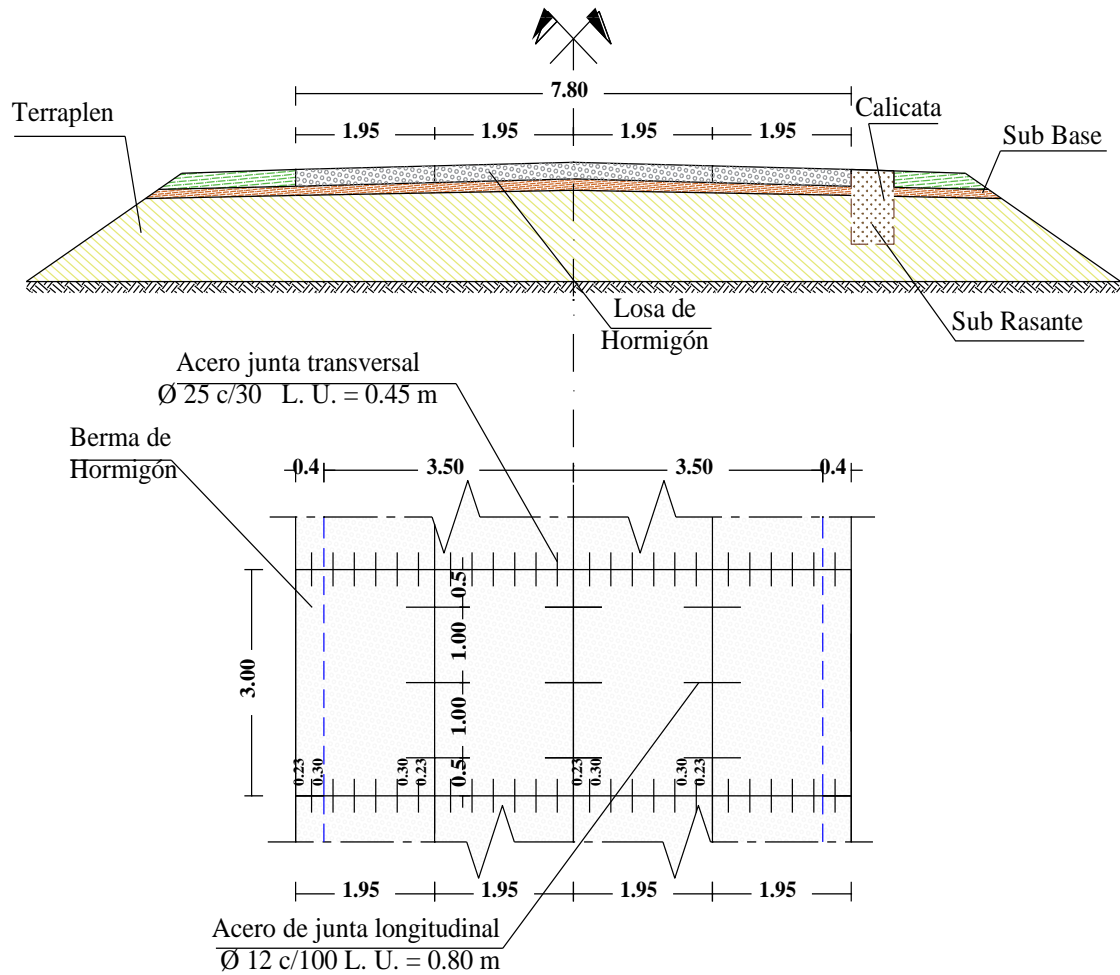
Vista en planta y sección transversal del pavimento en las progresivas 16+000 y 17+000
